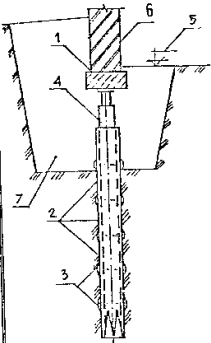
Схема вдавлювання палі: 1 – гідравлічний домкрат; 2 – змінний вкладиш; 3 – відрізок вдавлюваної труби; 4 – анкерна тяга; 5 – отвір у ростверку
